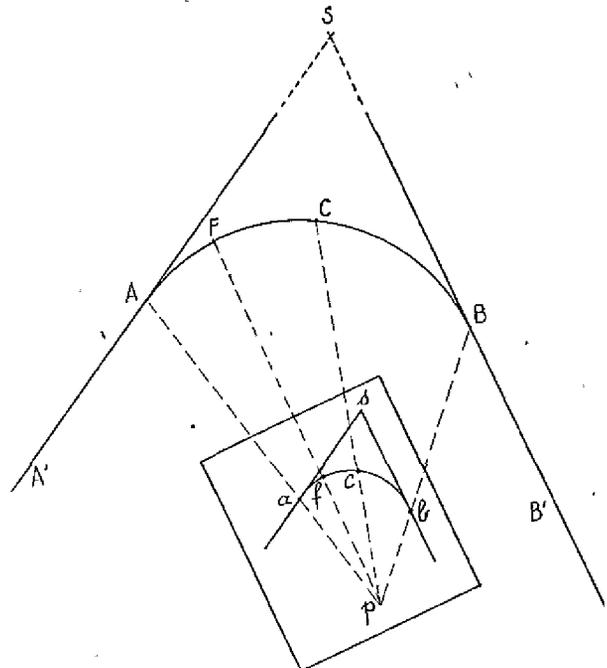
Tracé d'un arc de cercle à la planchette. Si le plan est dessiné à l'échelle de 1/100^e on a :
